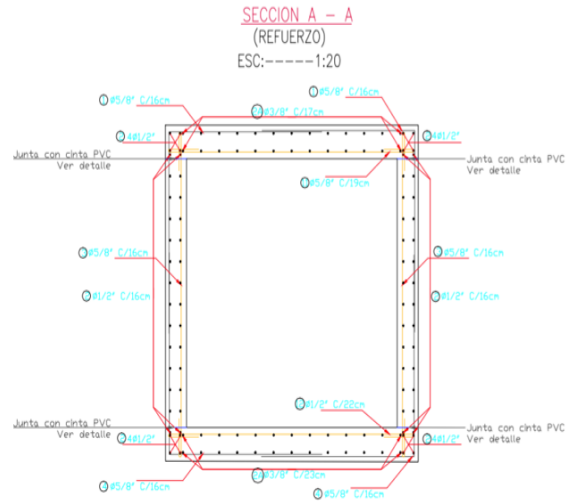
Vista frontal del encofrado y del plano del Box coulvert 2 X 2 m.
